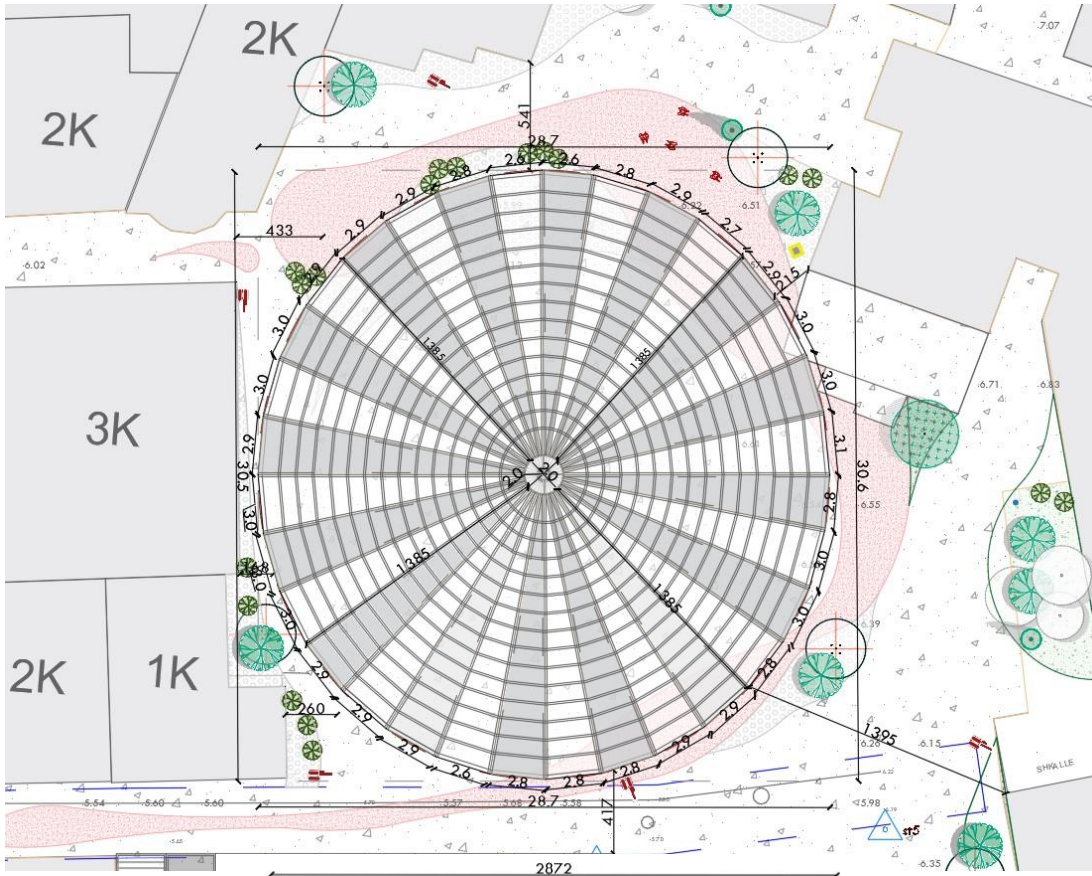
Plan vendosje dhe plan i organizimit funksional
